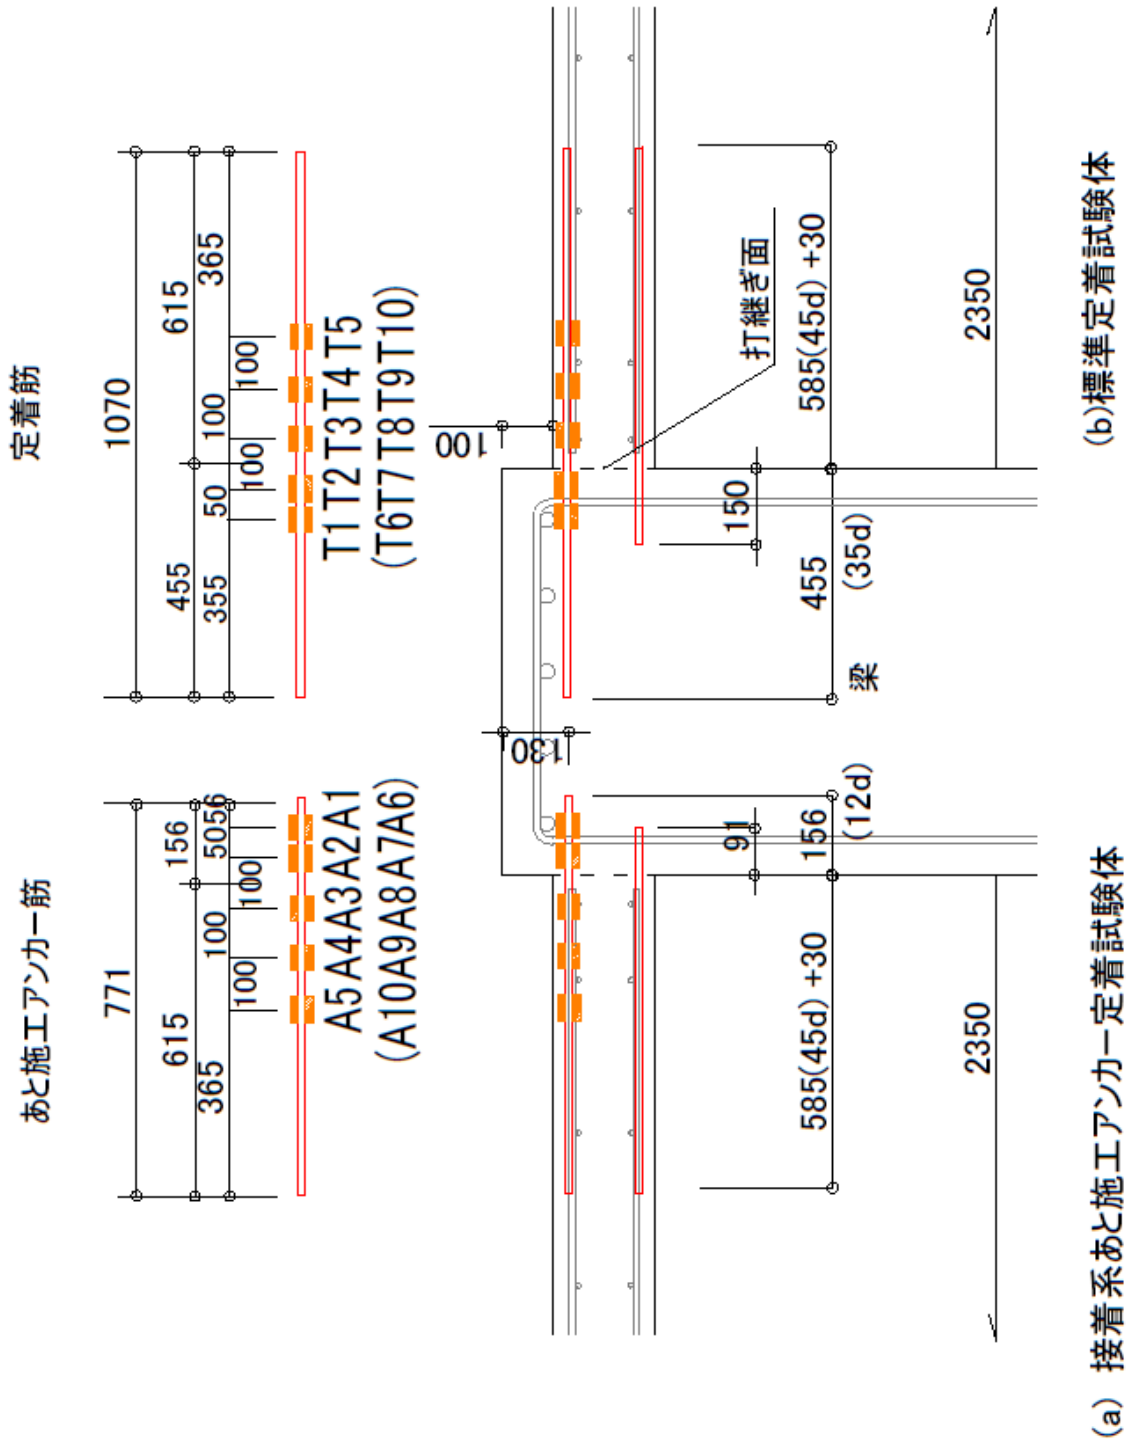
鉄筋(あと施工アンカー筋, 定着筋)ひずみ測定位置(CA, CB 試験体)
